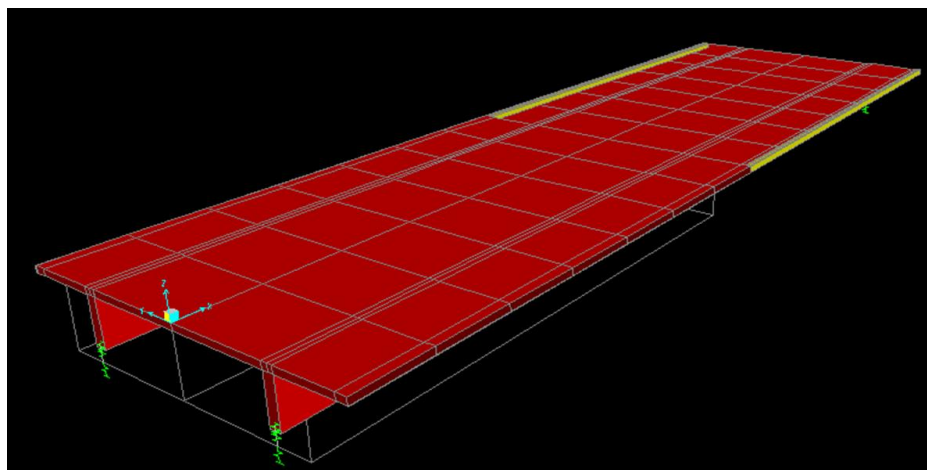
Modelo de ponte em vigas gerado pelo bridge modeler do SAP2000 (SILVA (2016))
